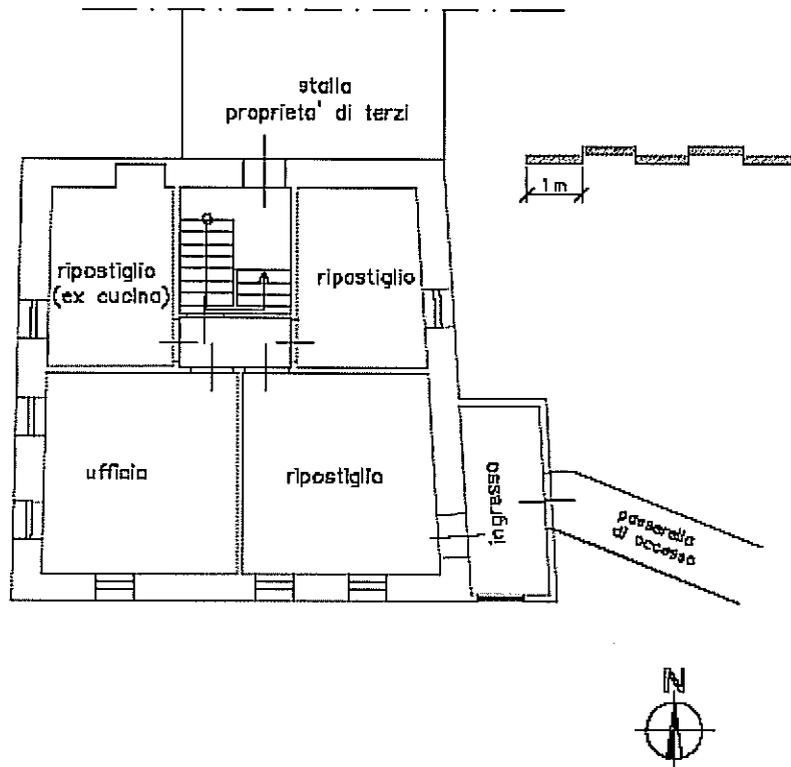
PIANO SECONDO (SOFFITTA)
